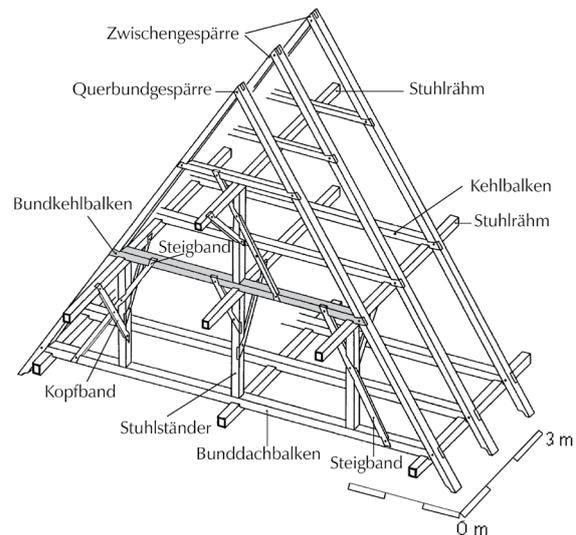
Sparrendach mit quer eingebundenen Sparrenpaaren und verstärkenden Einbauten aus der Kombination von stehendem Quer- und Längsbund (dreifach stehender Stuhl) im 1. Dachgeschoss sowie einfach stehendem Stuhl im 2. Dachgeschoss. In den Zwischengespärren gibt es verstärkende Einbauten in Form von Kehlbalken. Schwäbisch Hall (Lkr. Schwäbisch Hall), Lange Str. 9, 1394 (d).
